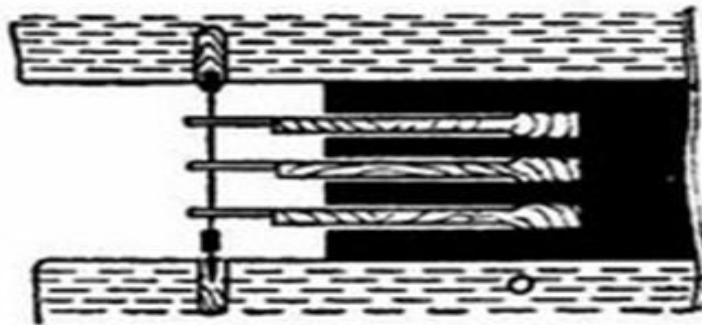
Расположение шпуров и приспособлений для измерения смещения угля
